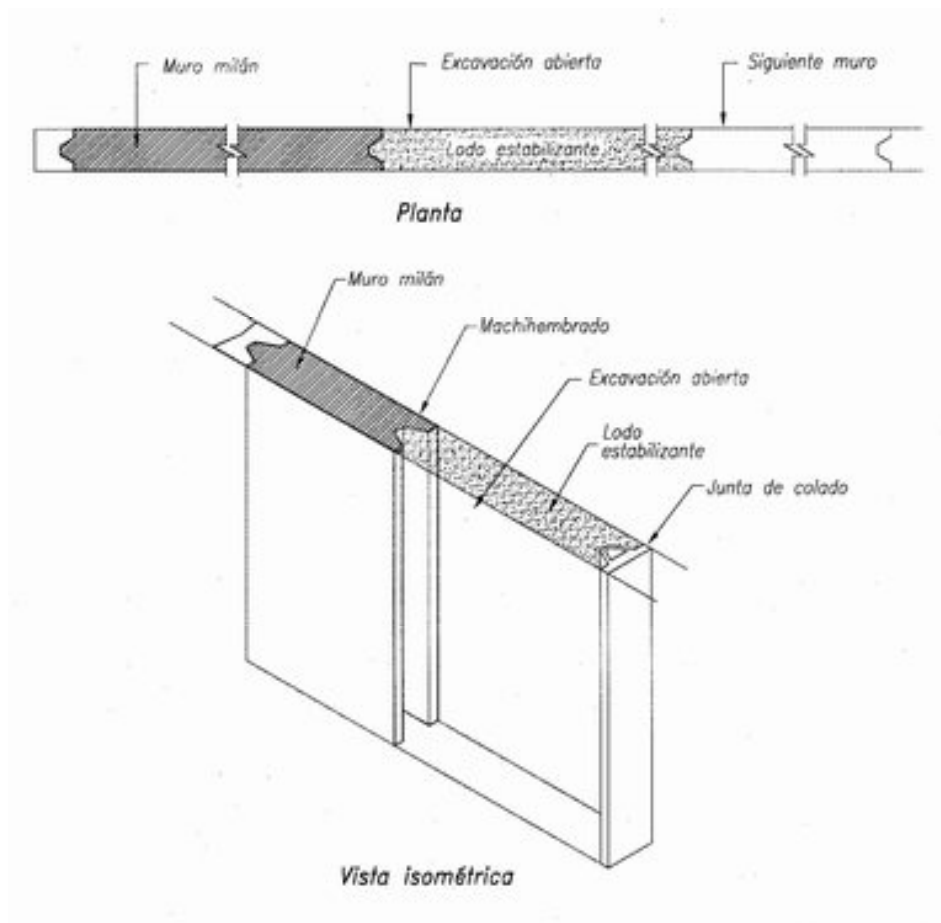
, Juntas de colado para formar el machihembrado del muro milán
